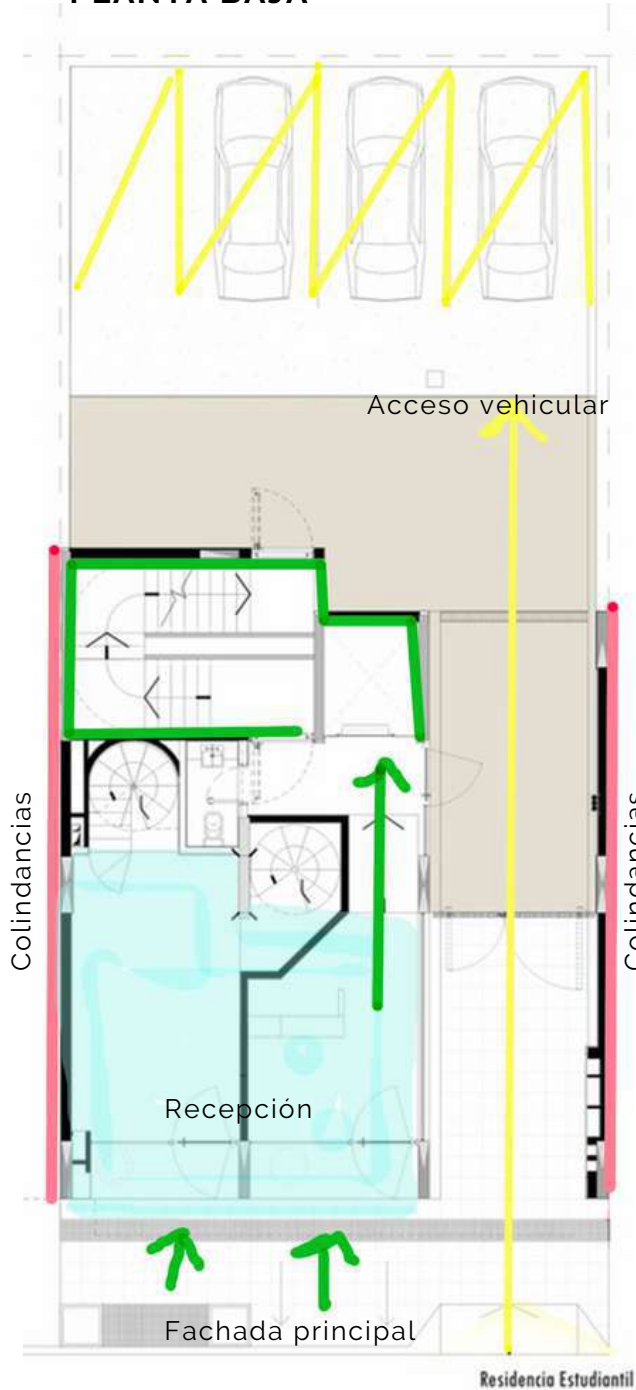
Planta arquitectónica intervenida con análisis. Fuente: Autoría propia.
